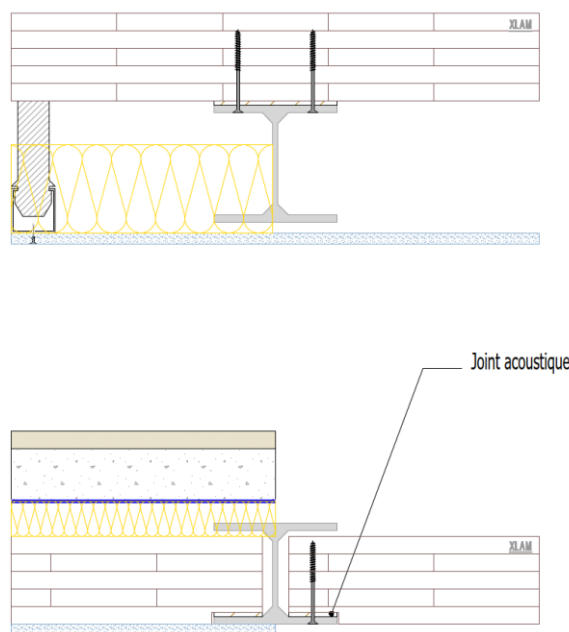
Détail d'assemblage de plancher XLAM sur mur XLAM
